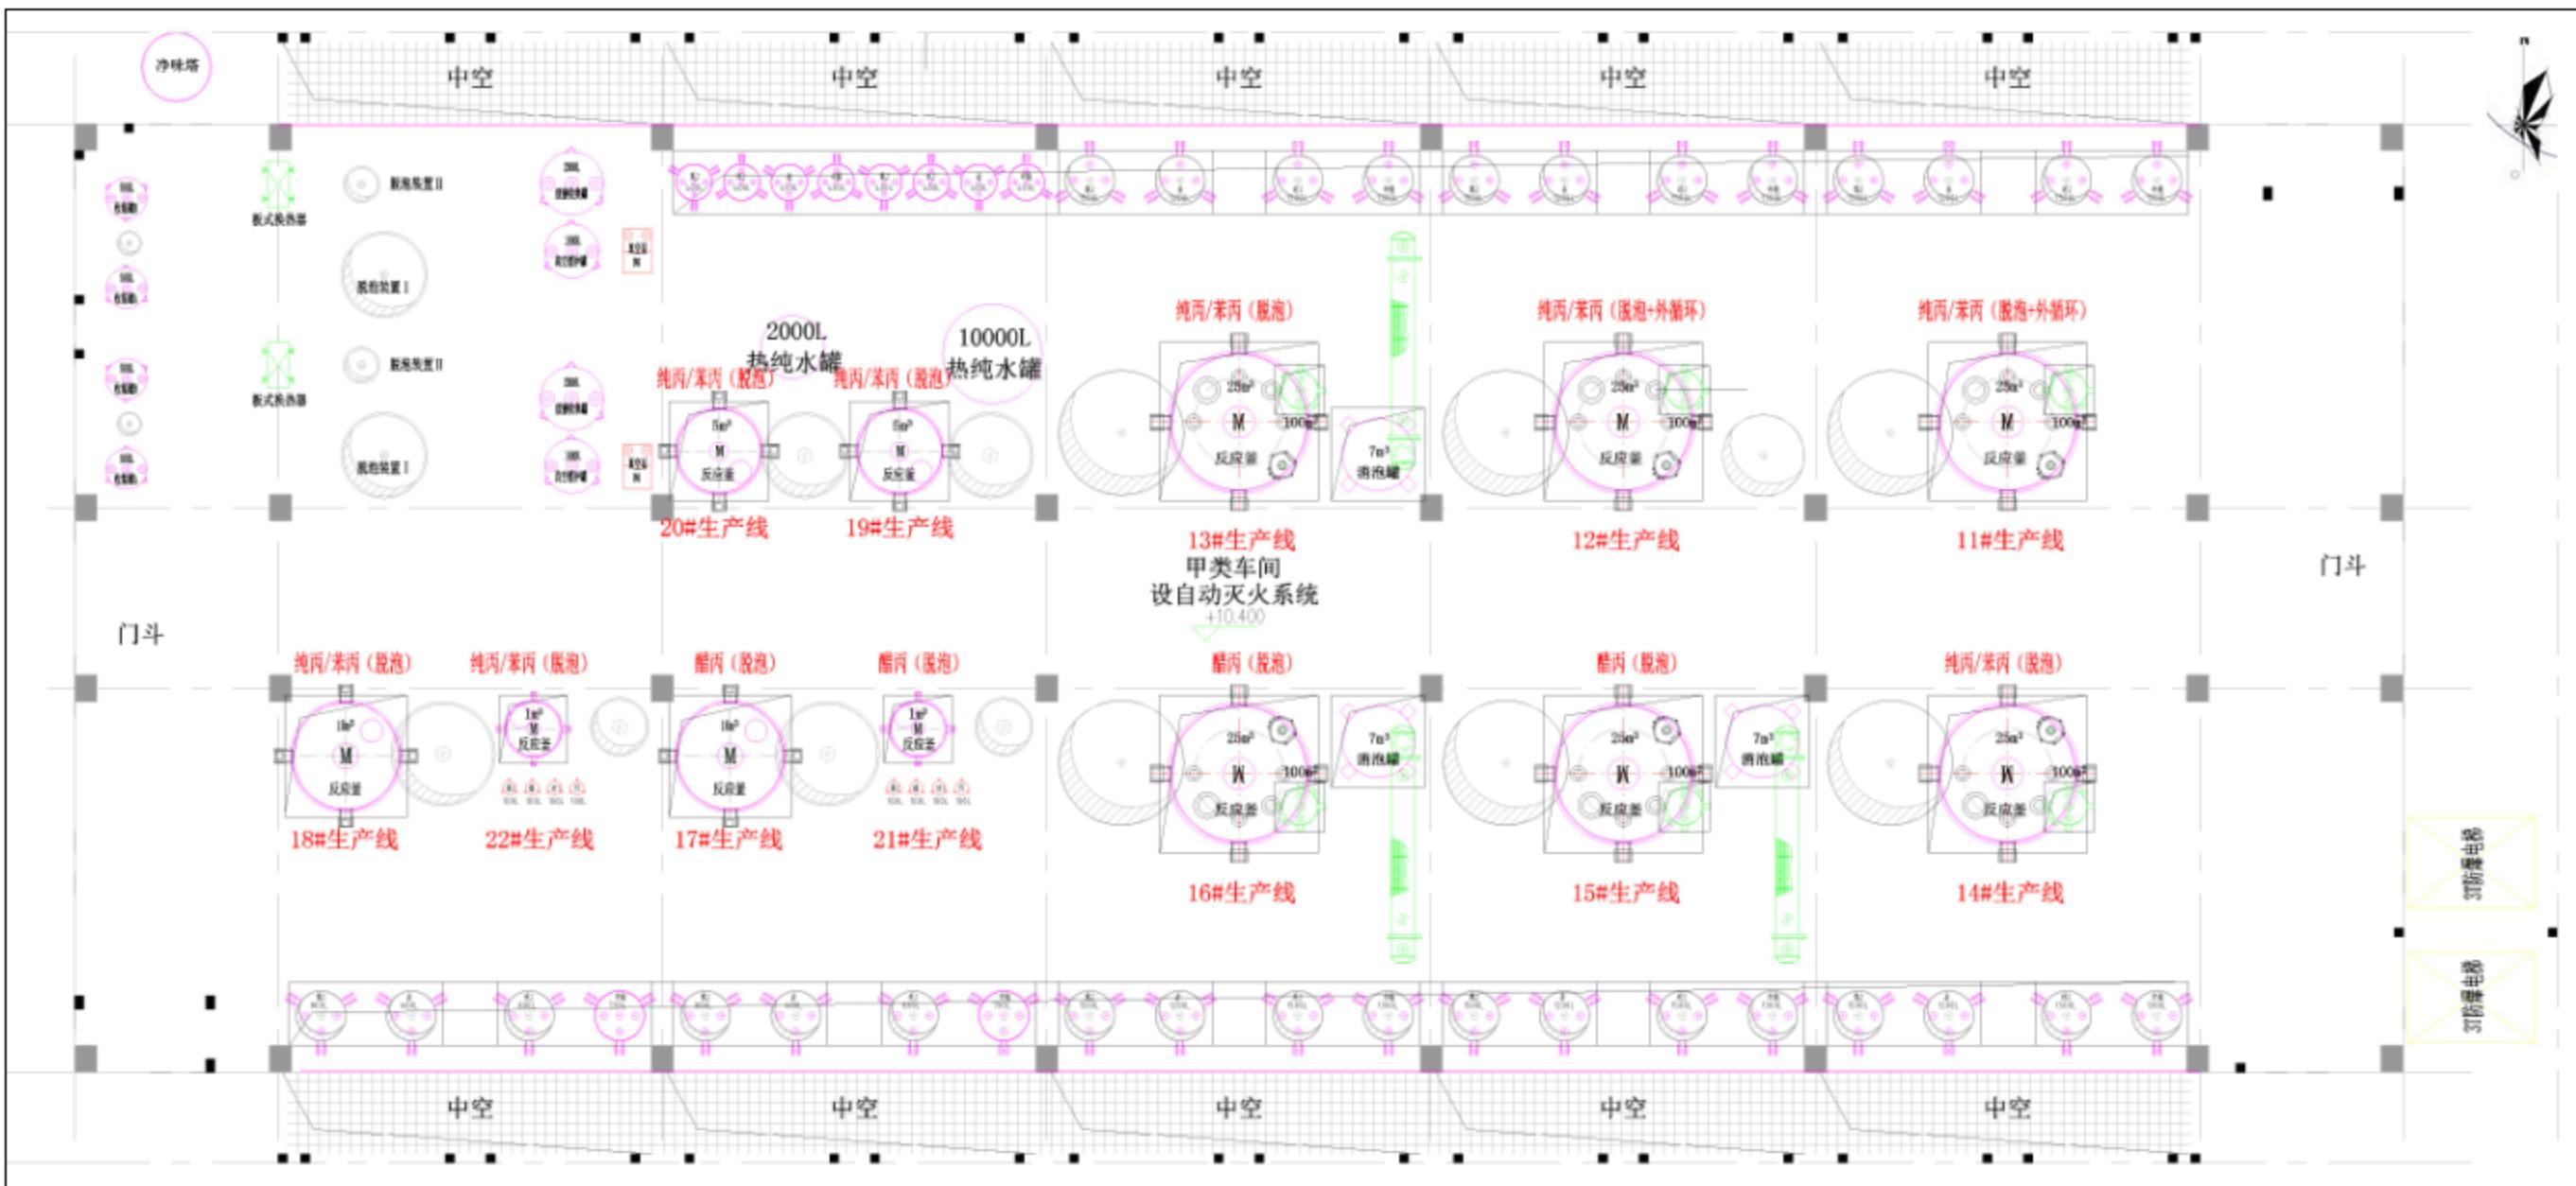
甲类车间B3层平面布置图 (比例尺1:100)
